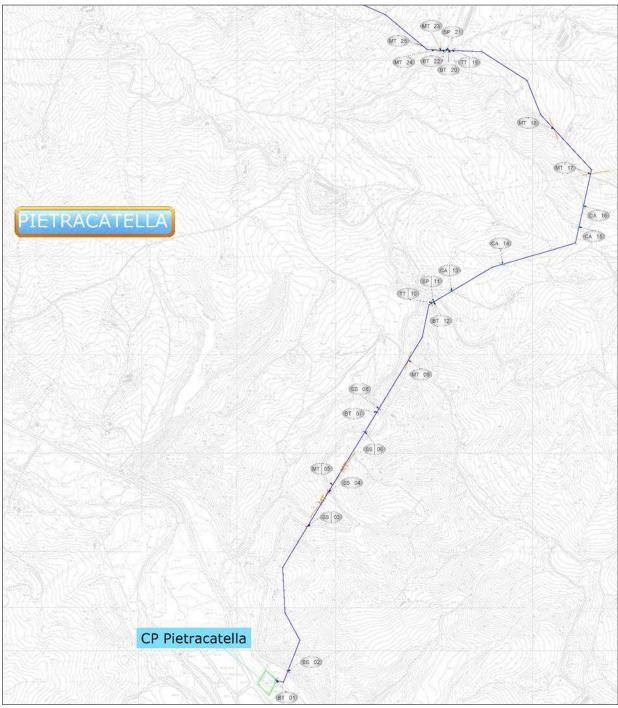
Stralcio planimetria tracciato elettrodotto su CTR (1/5)
